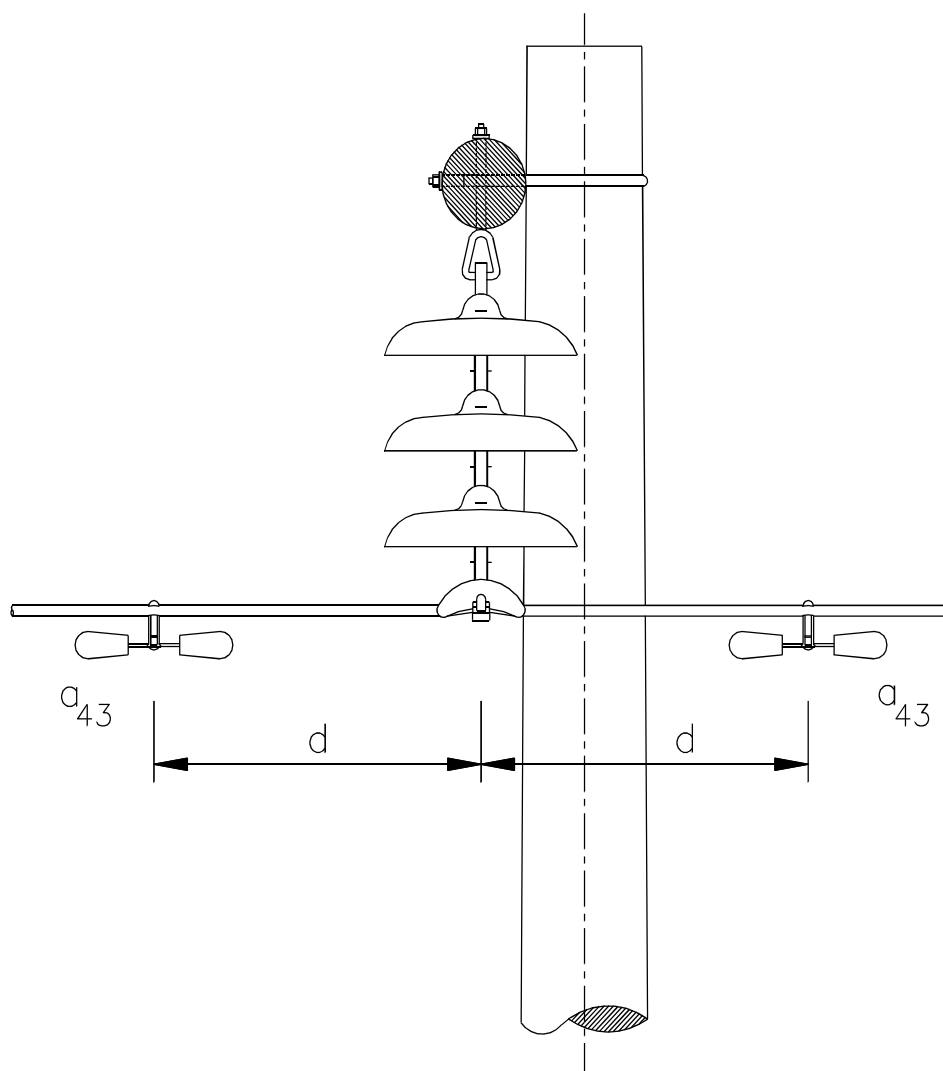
Instalación de amortiguador tipo Stock bridge
